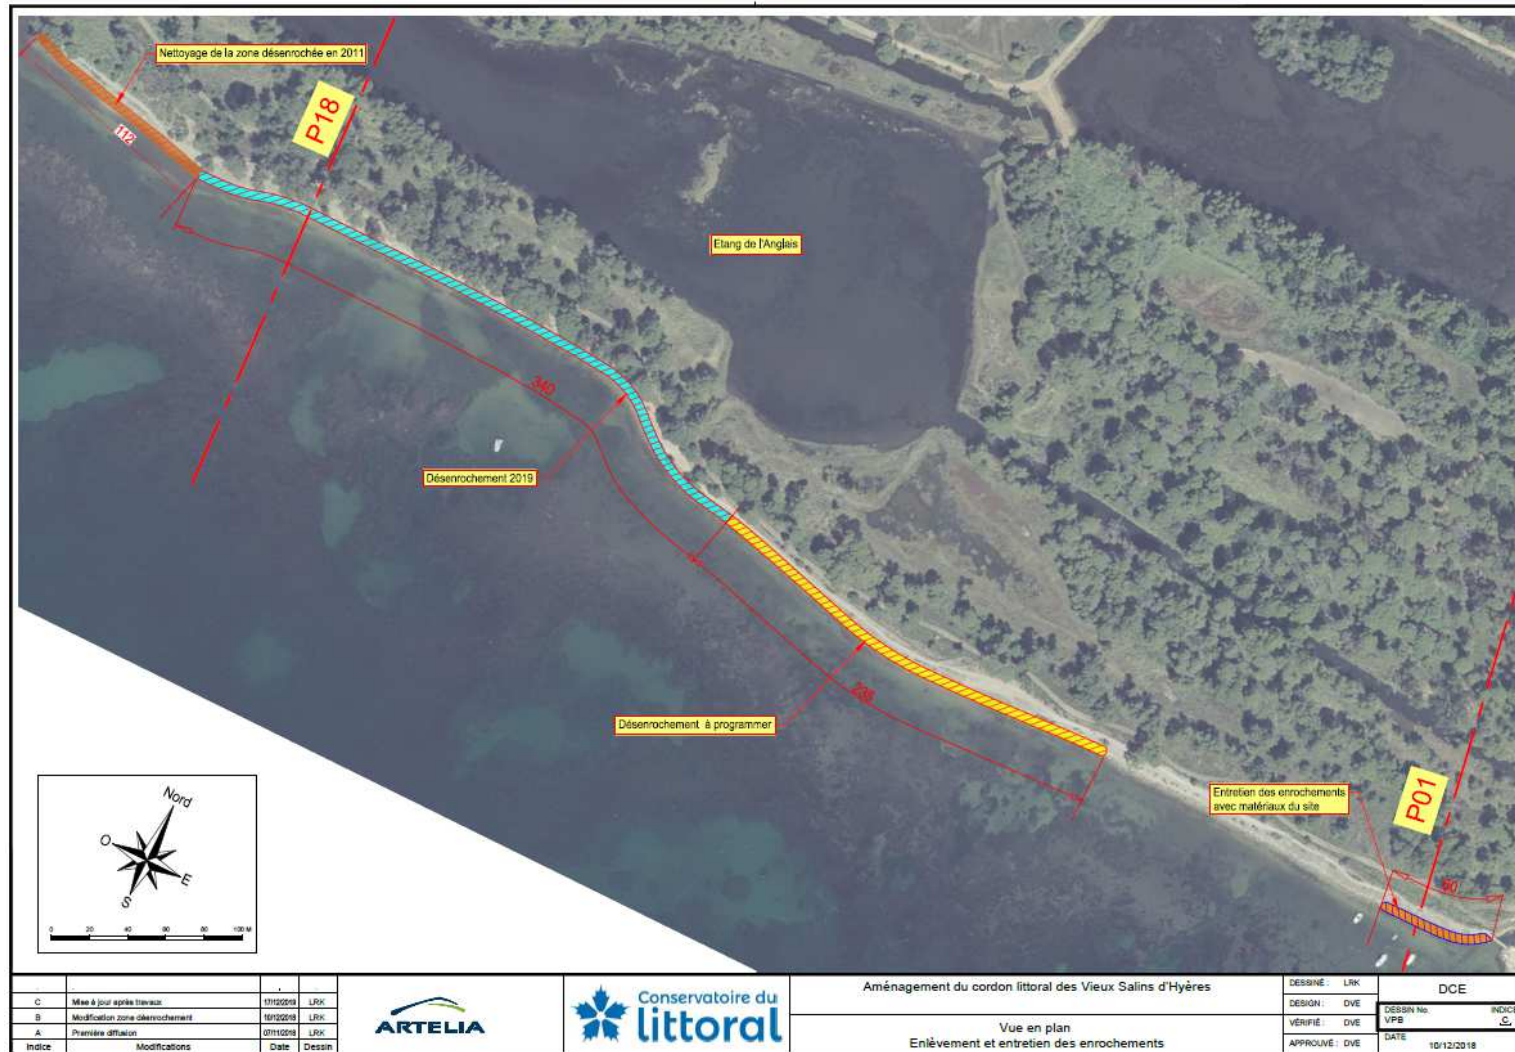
Plan des travaux de suppression et d'entretien des enrochements
